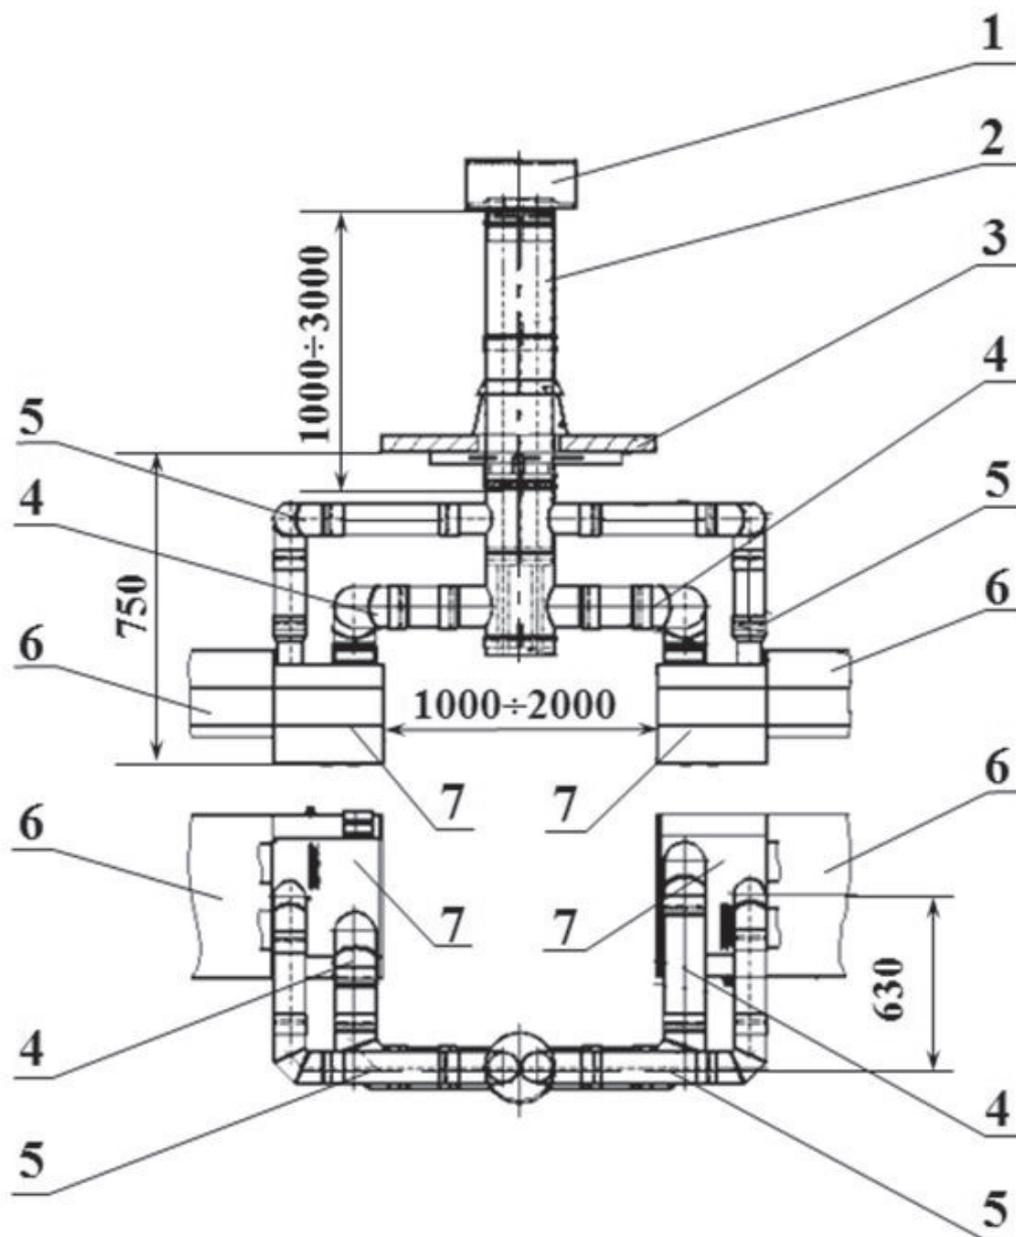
Схема системы LAS-Duplex для удаления дымовых газов от двух одновременно работающих обогревателей: 1 – накрывное устройство от дождя; 2 – наружная труба; 3 – потолок помещения; 4 – трубопровод для подвода наружного воздуха; 5 – трубопровод для отвода продуктов сгорания от горелки; 6 – теплоизлучающая лента обогревателя; 7 – газогорелочный блок
